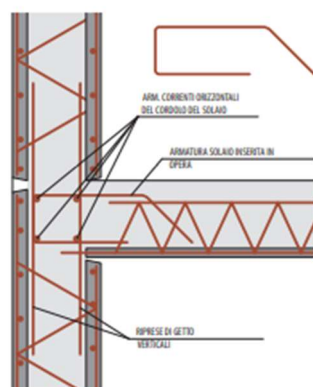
collegamenti verticali tra due BILASTRA® e solaio prefabbricato
